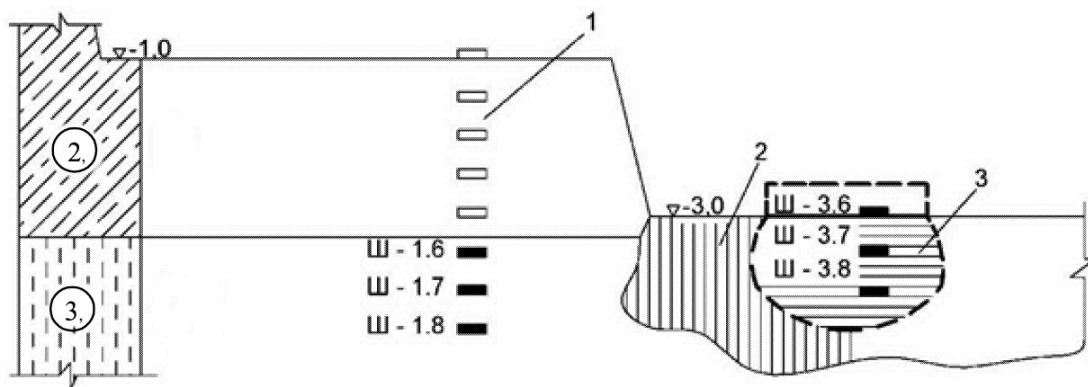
Схема полевых испытаний опытными штампами: 1 – природный грунт; 2 – грунт, уплотненный тяжелой трамбовкой; 3 – зона деформации после испытания опытными фундаментами
